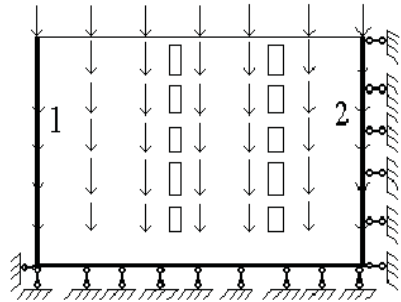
Схематичне зображення розрахункових схем першого та другого варіантів розрахунку: 1, 2 - стрижневі КЕ, що моделюють поперечні стіни будівлі.
